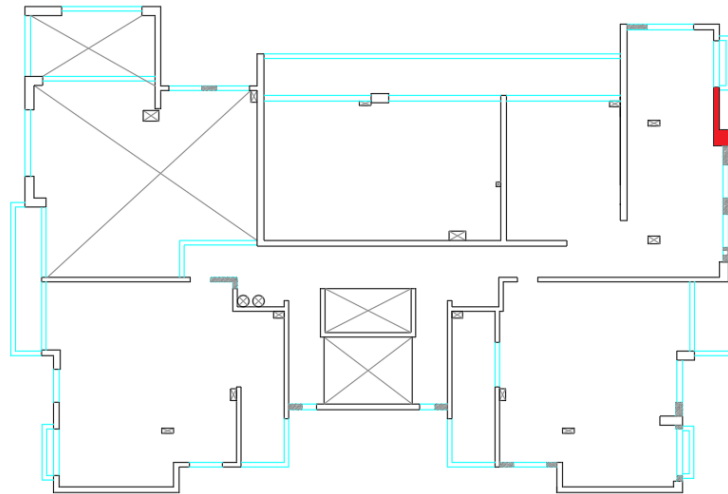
Ubicación del muro dañado en la fachada oriente del primer piso.
